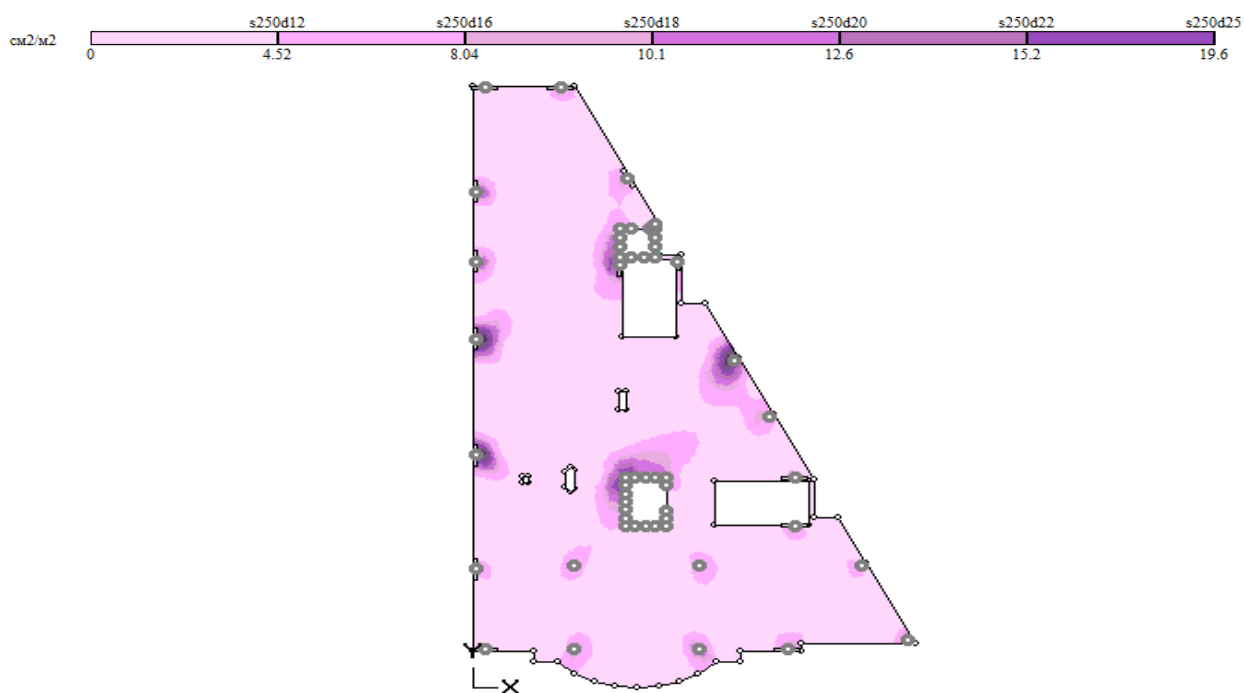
Схема розташування верхньої арматури вздовж цифрових осей у плиті
